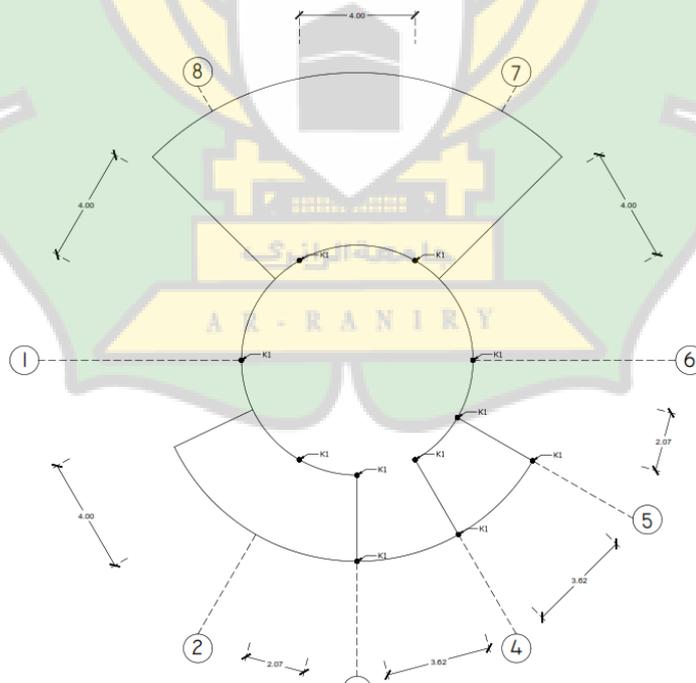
Denah Kolom Lantai 1 Lobby dan Pengelola
